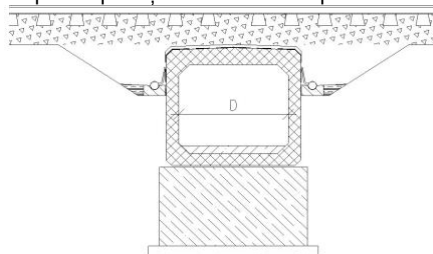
Exemplu de podet realizat din cadre prefabricate din beton armat
